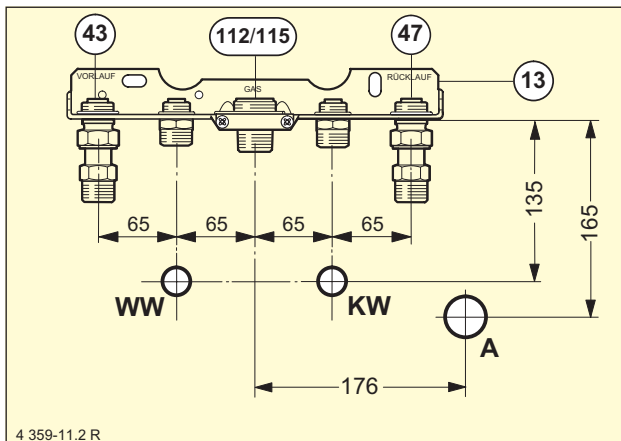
Aufputzanschlüsse mit Wandabstand 60 mm.
